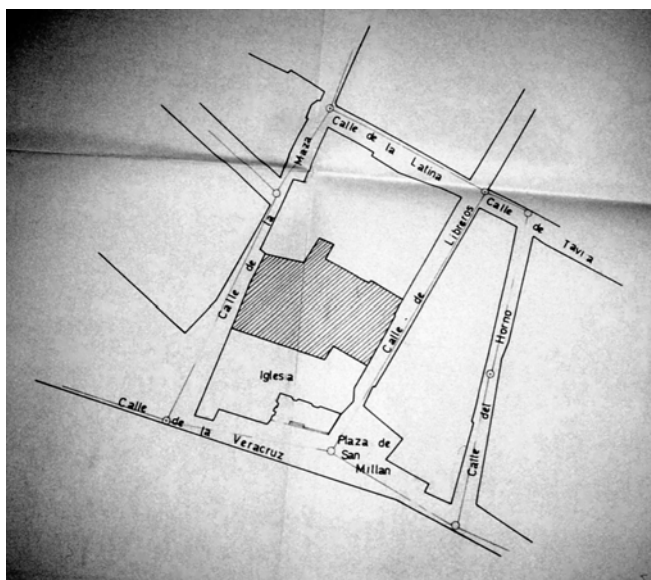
Biblioteca de Santa María de los Ángeles: plano de situación.
